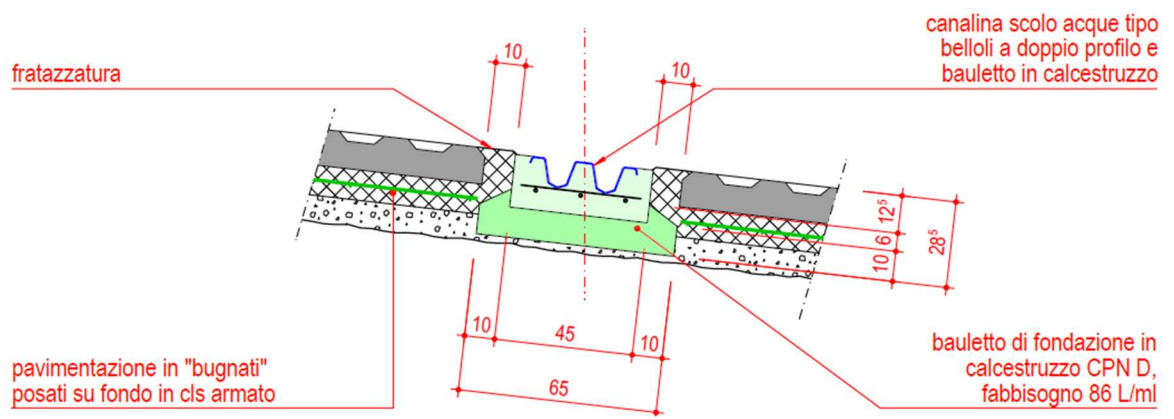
Sezione tipo nuove canalette nella pavimentazione con bugnati invertiti
